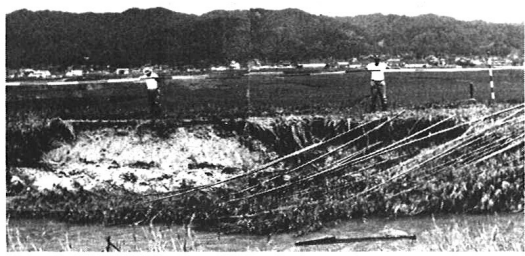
堤防表水面での側岸侵食の進行(石川県又江川)
